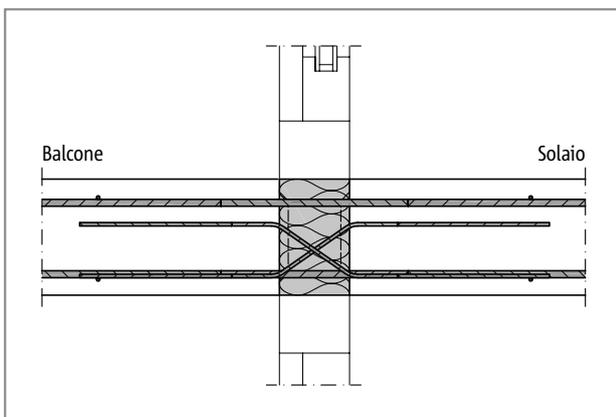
Schöck Isokorb® tipo DXT: sezione costruttiva; solaio monodirezionale
